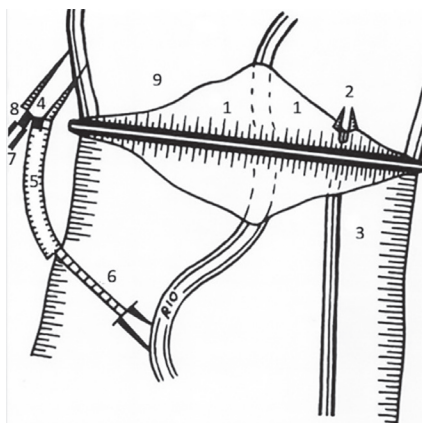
Planta de un sistema hidráulico fluvial de carga pequeña con presa de material del lugar.
